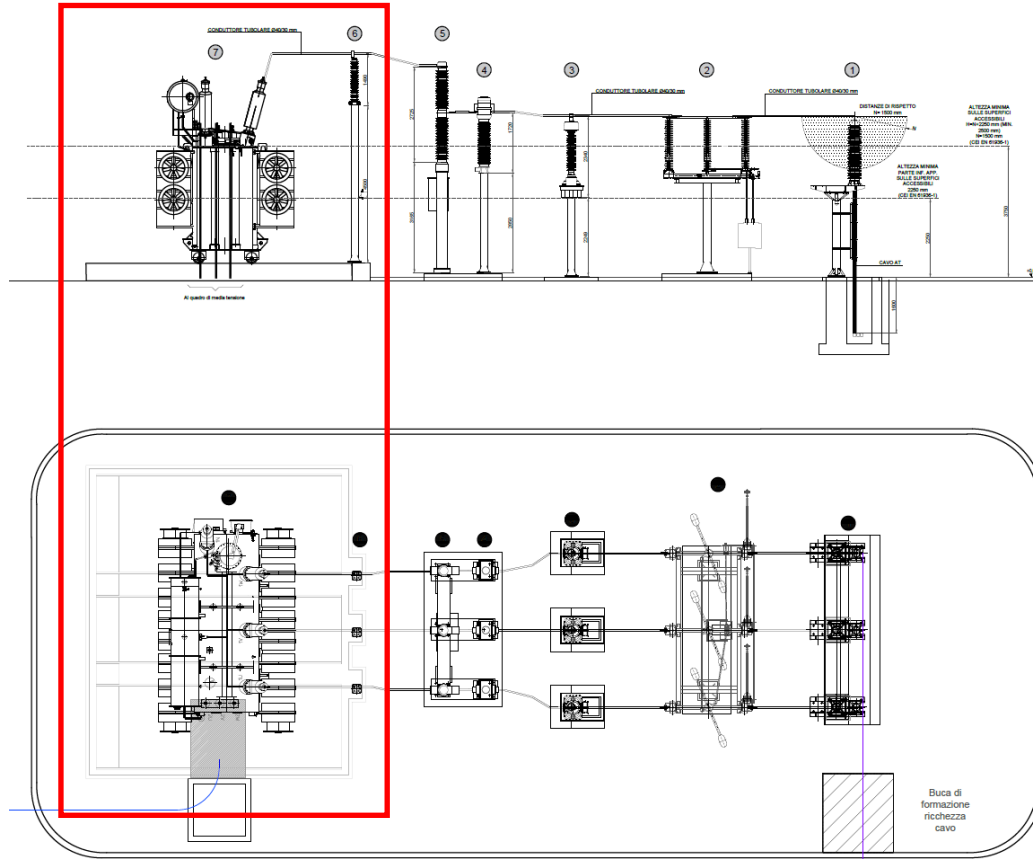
Prospetto e planimetria degli elementi della sottostazione utente.
